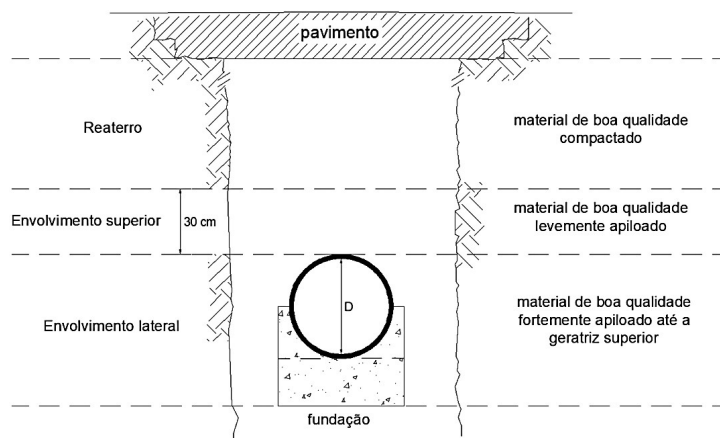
Apoio sobre laje e berço de concreto com fundação
